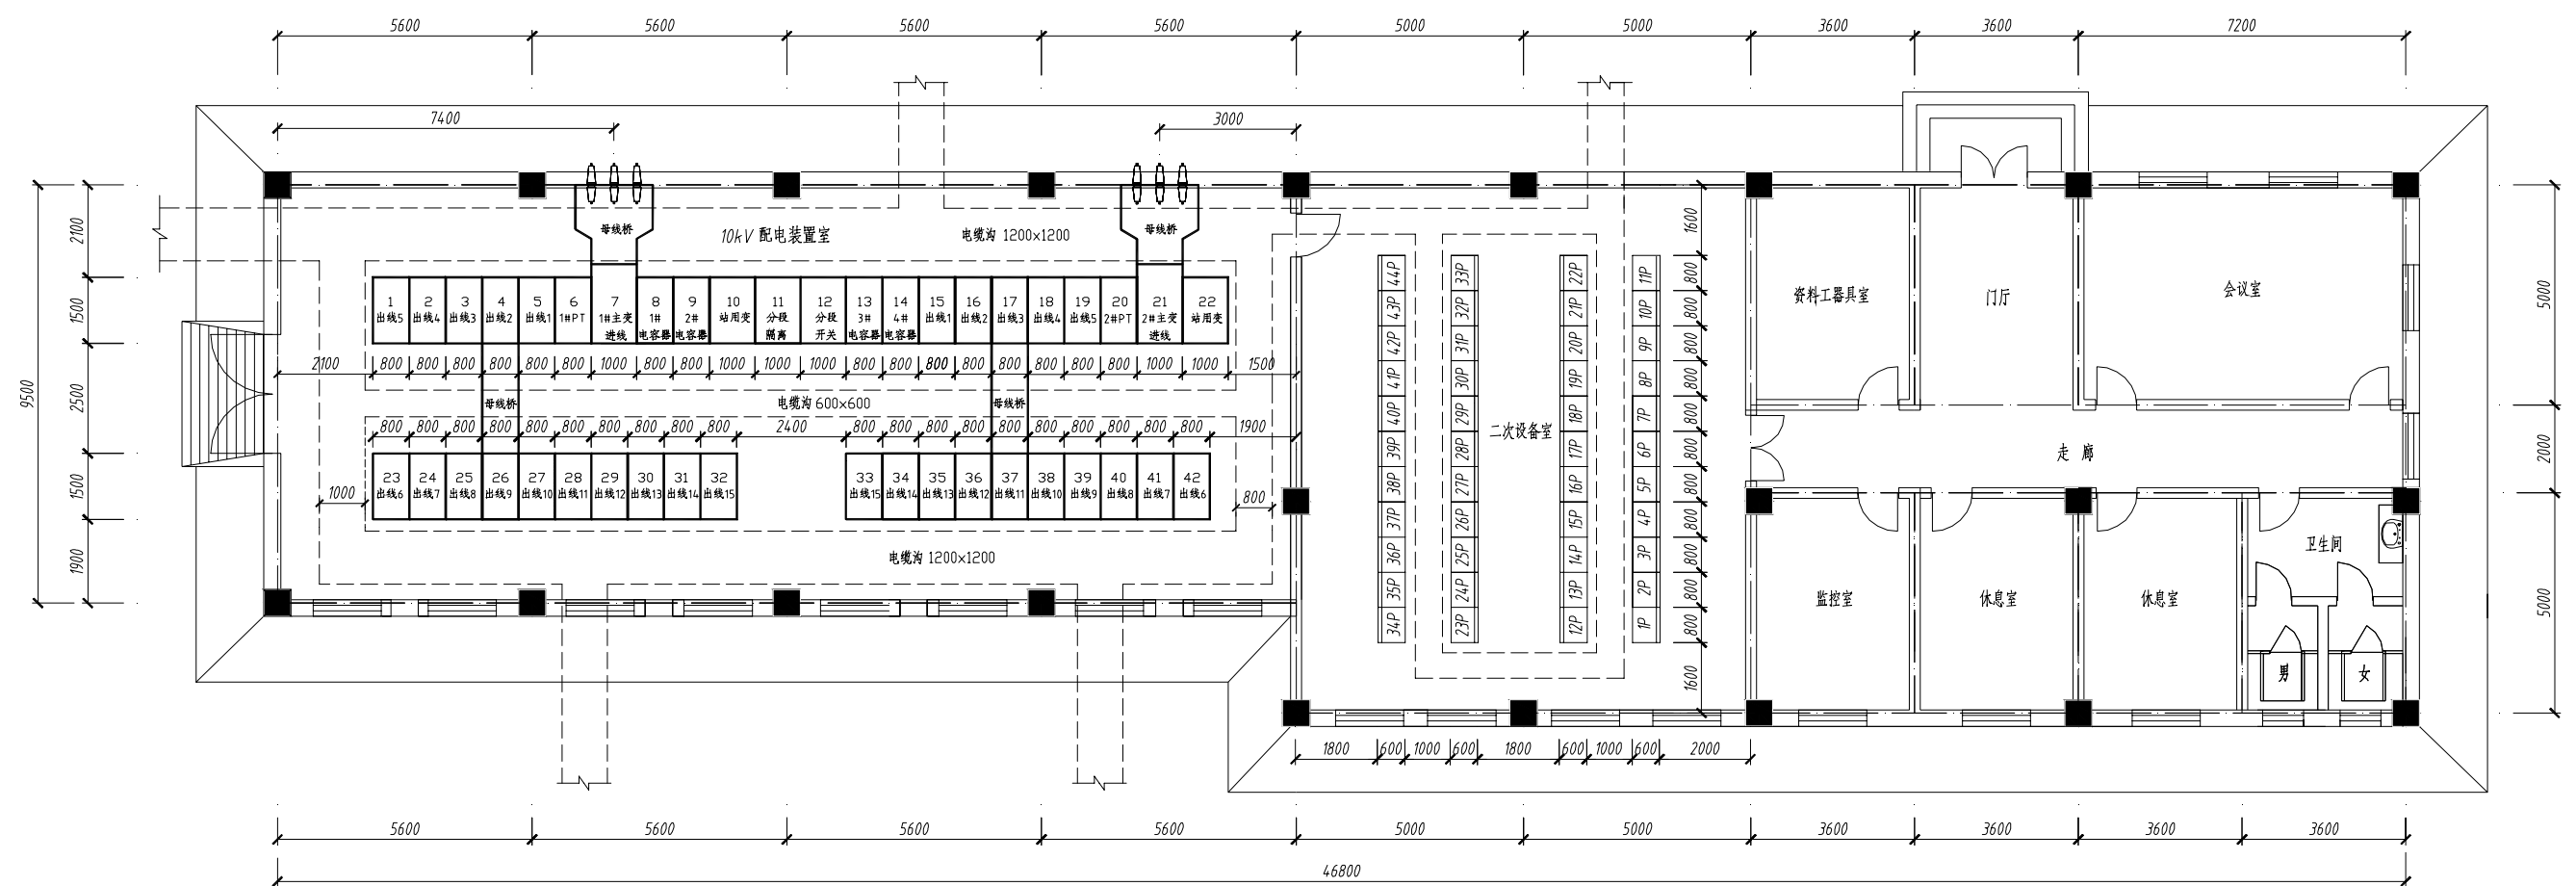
综合配电室电气平面布置图 (C1-1-03)
